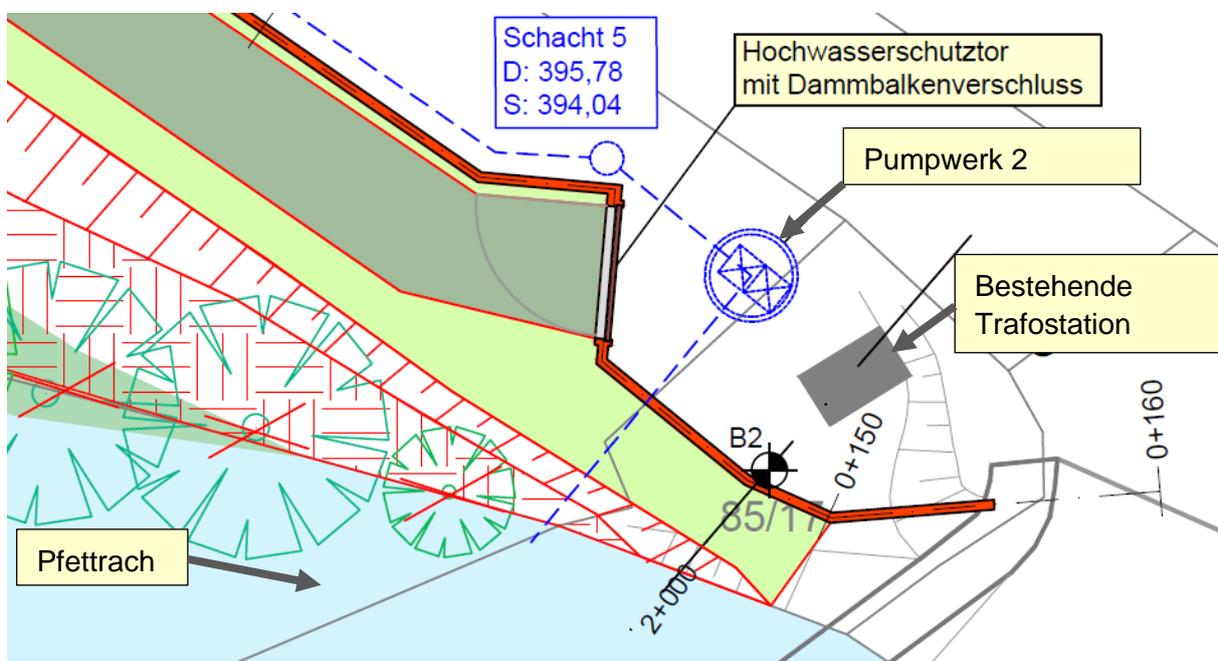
Lage des Schachtpumpwerks 2 (Ausschnitt aus Lageplan E 21)
